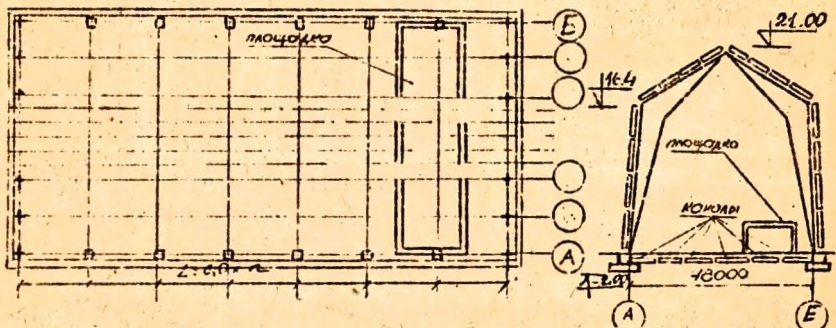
Главный корпус ремонтного завода (к схеме 9).
